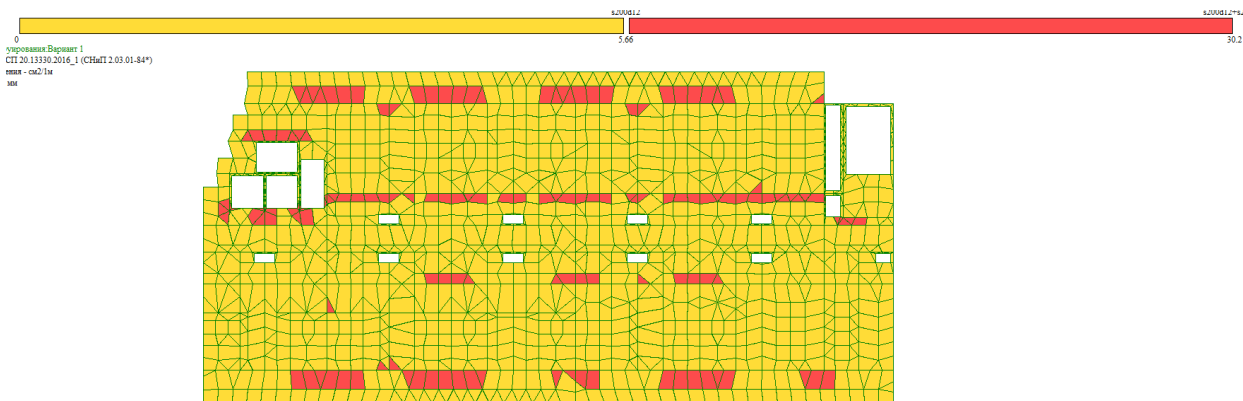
Подбор верхней продольной арматуры плиты
